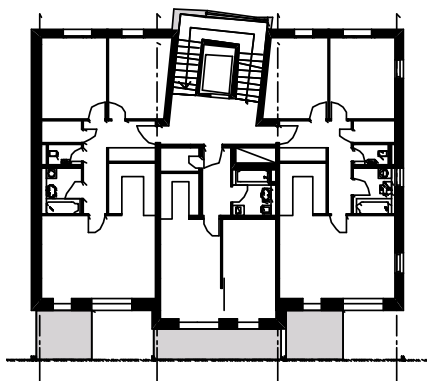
Grundriss (Quelle: Schöberl & Pöll)
